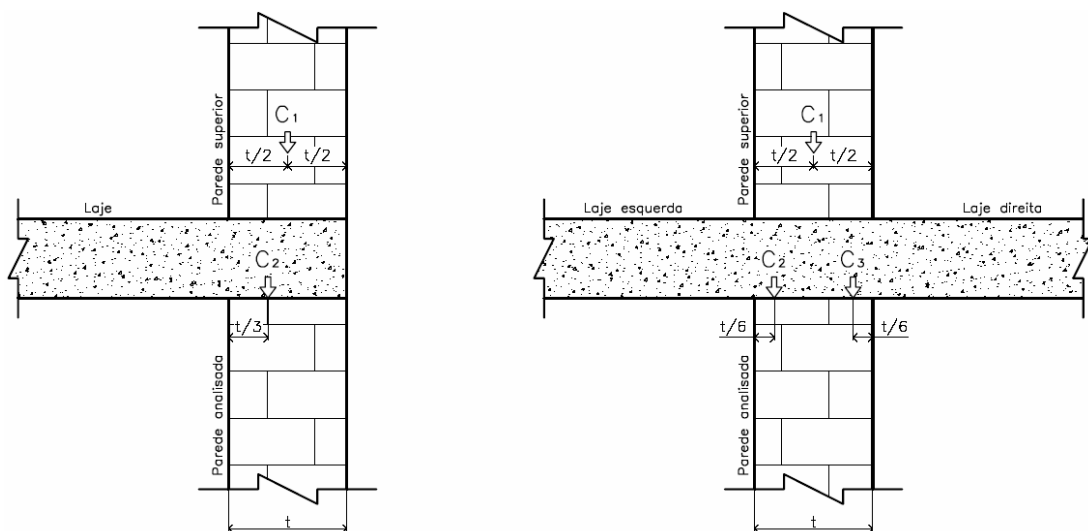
Pontos de aplicação do carregamento da laje na parede
